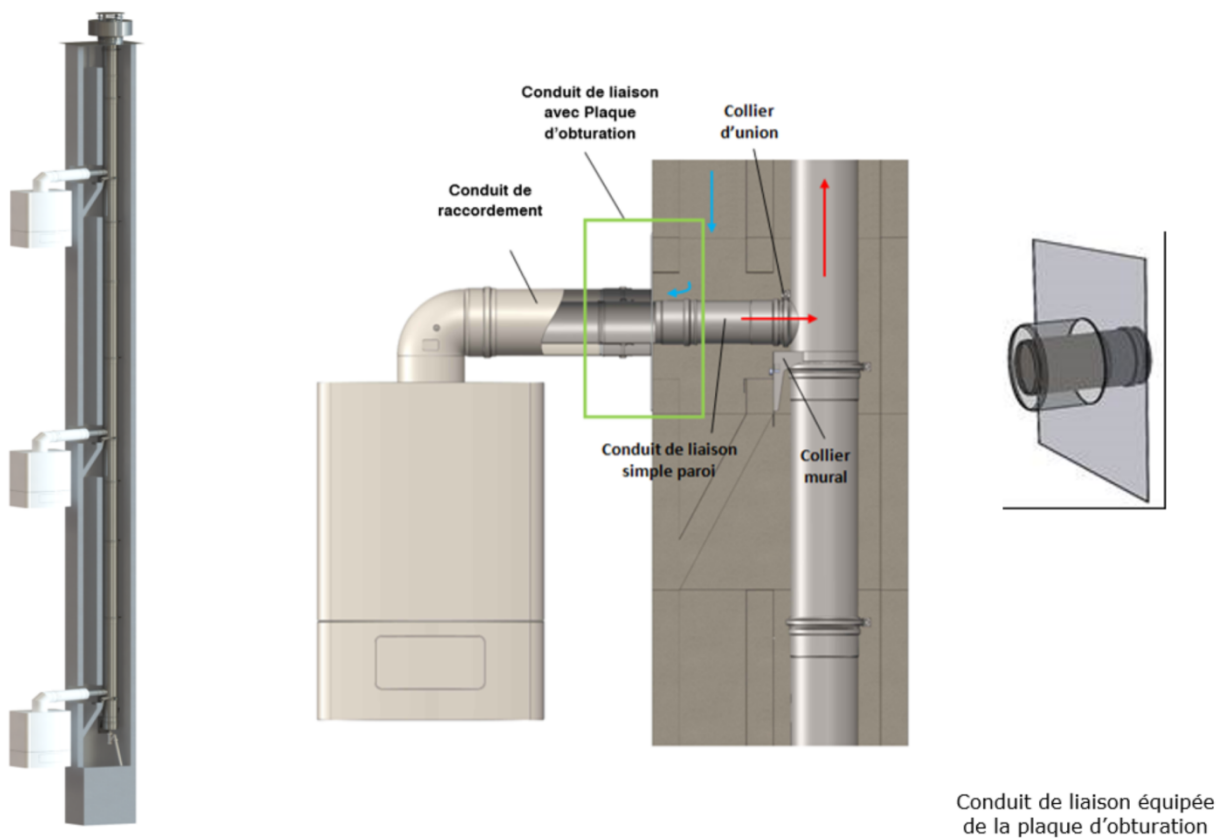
Principe de montage de la version DINAGAS 3CE+ SW à l'intérieur d'un conduit existant
